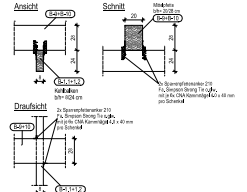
Anschluß Pos. B-12 u. B-14, M.1:20
